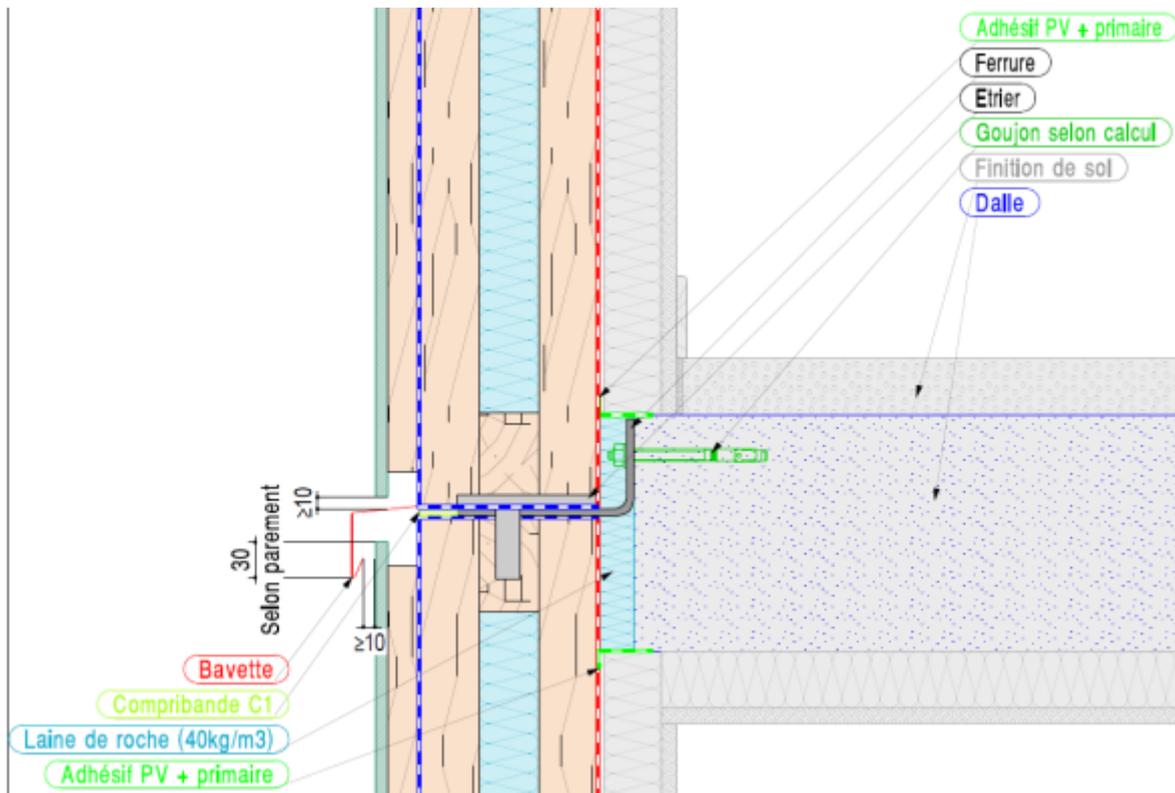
Raccord de panneaux sur dalle béton, fixation par empiement / coupe verticale
